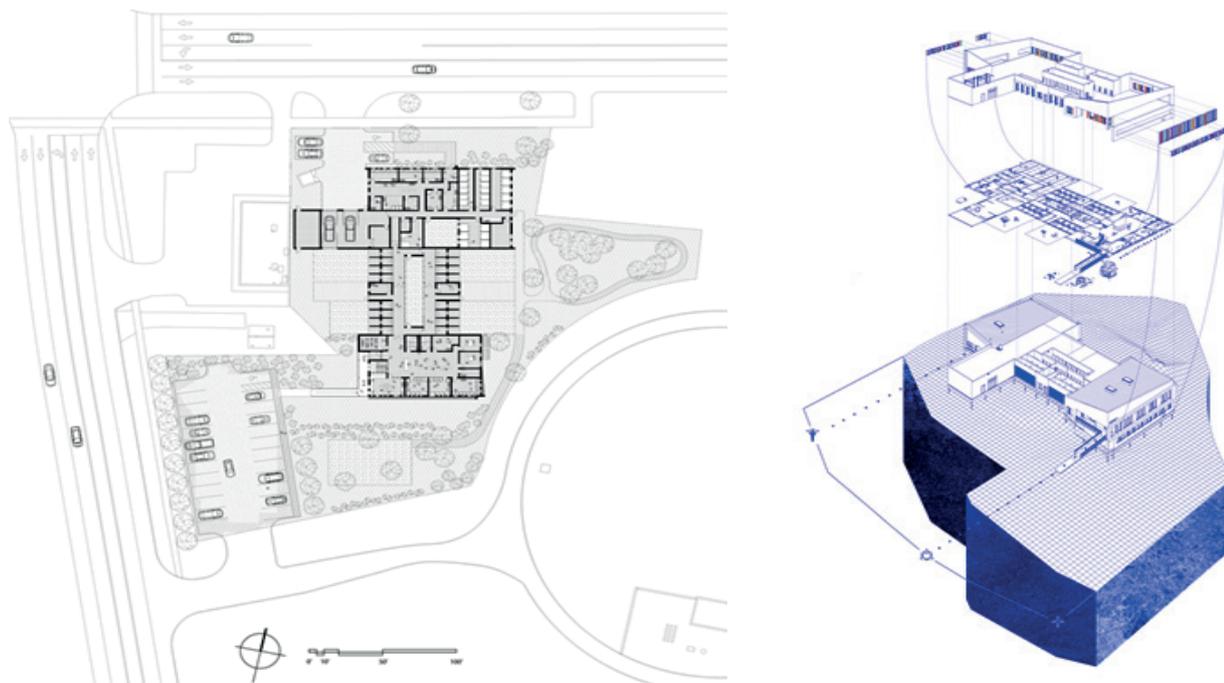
Генеральный план, совмещённый с планом 1-го этажа и суперпозиция [1]
